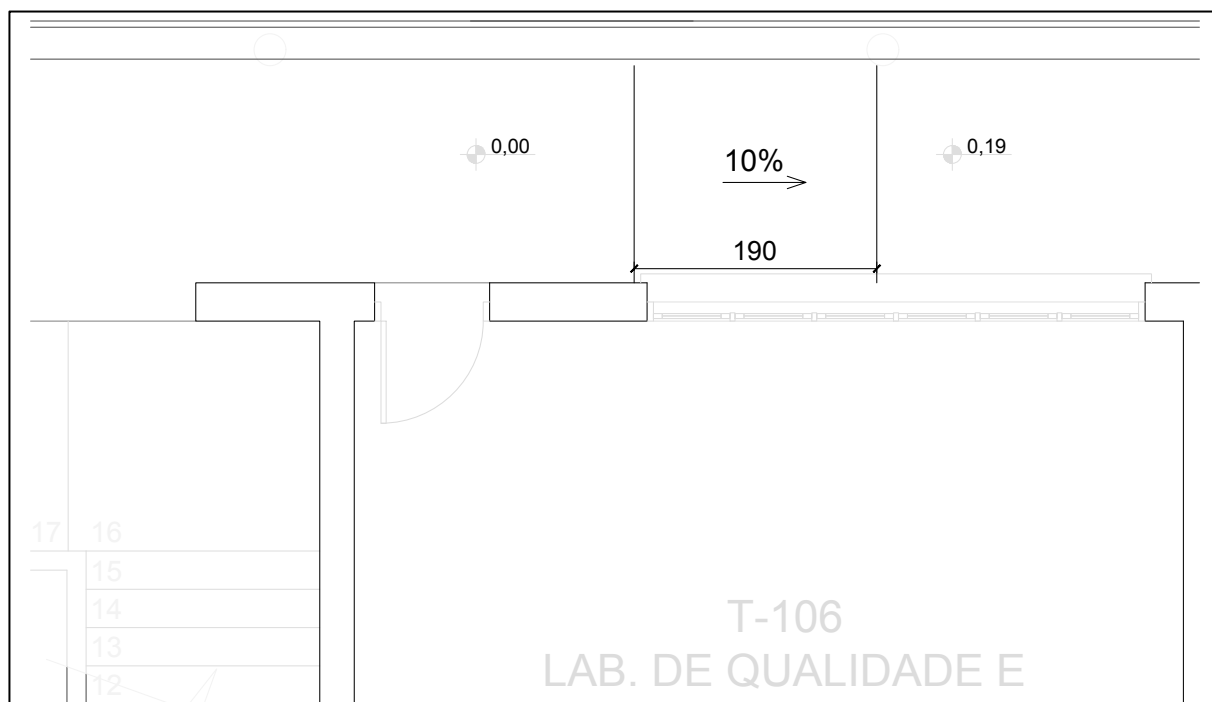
Proposta de alteração rampa 03. Fonte: autora.
